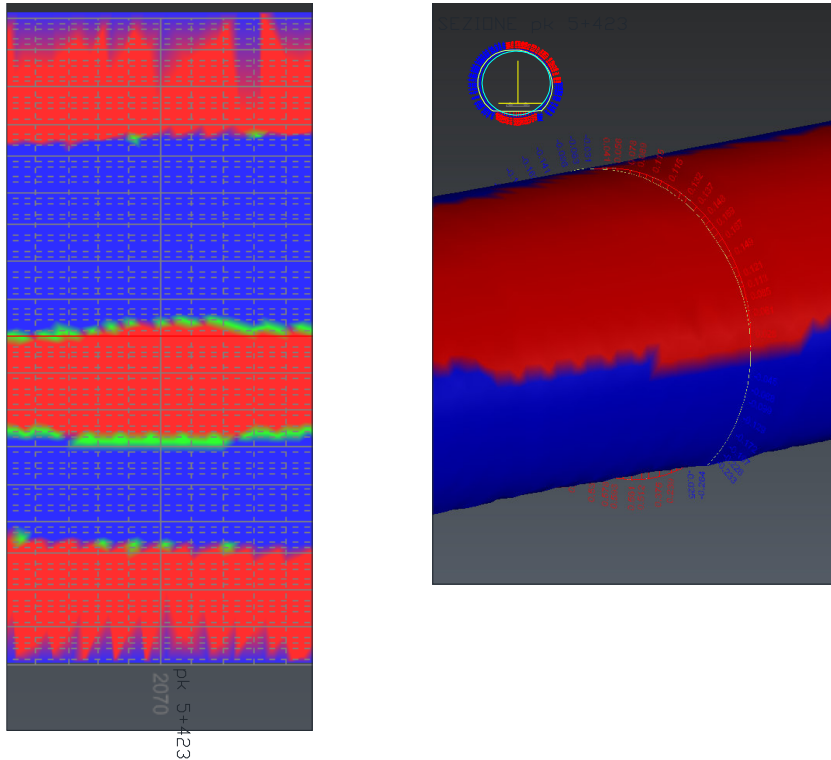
Visualizzazione in pianta ed in 3D della sezione alla pk 5+423
